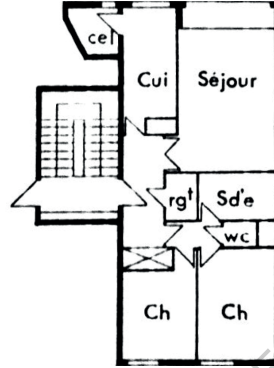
Plan d'un logement à Poitiers, ZUP des Couronnières, 1964
